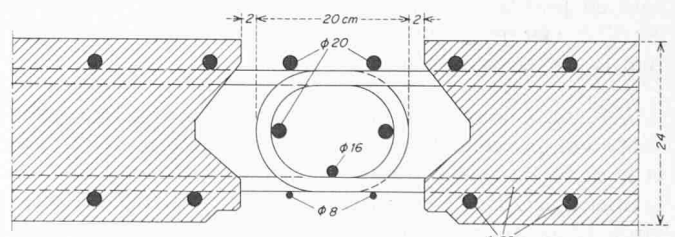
Détail d'un joint tendu à recouvrement court, 1:10
